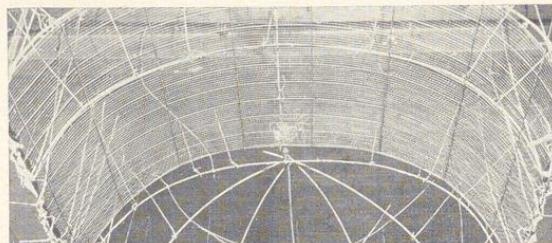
Mit Baustahlmatten ausgespannte Gewölbefläche
